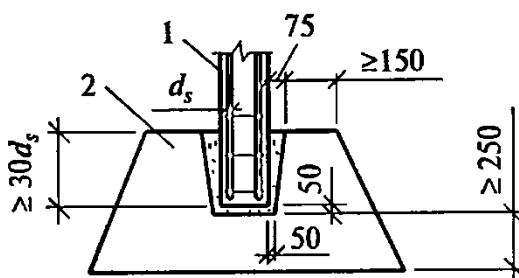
Глубина стакана фундамента: 1 — колонна; 2 — фундамент
